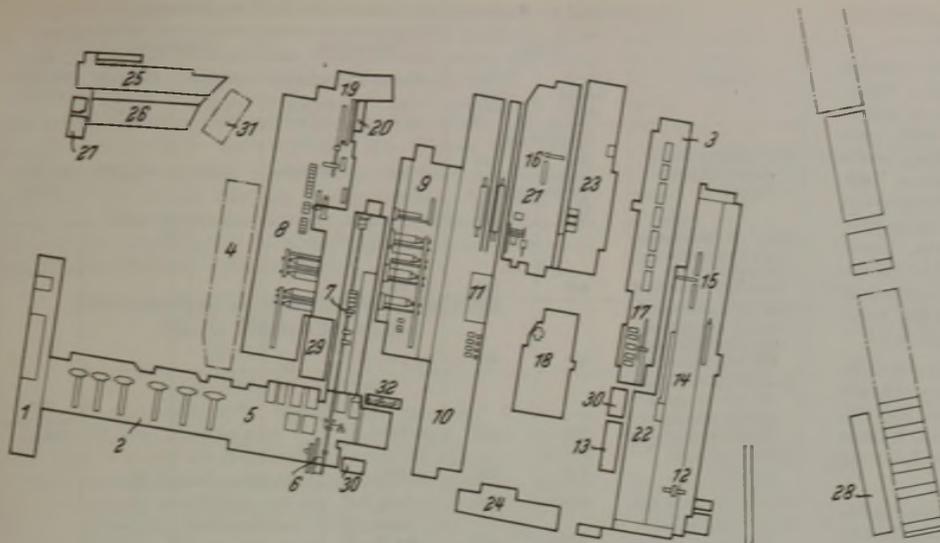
Lageplan der Allegheny Steel Co. in Brackenridge.
